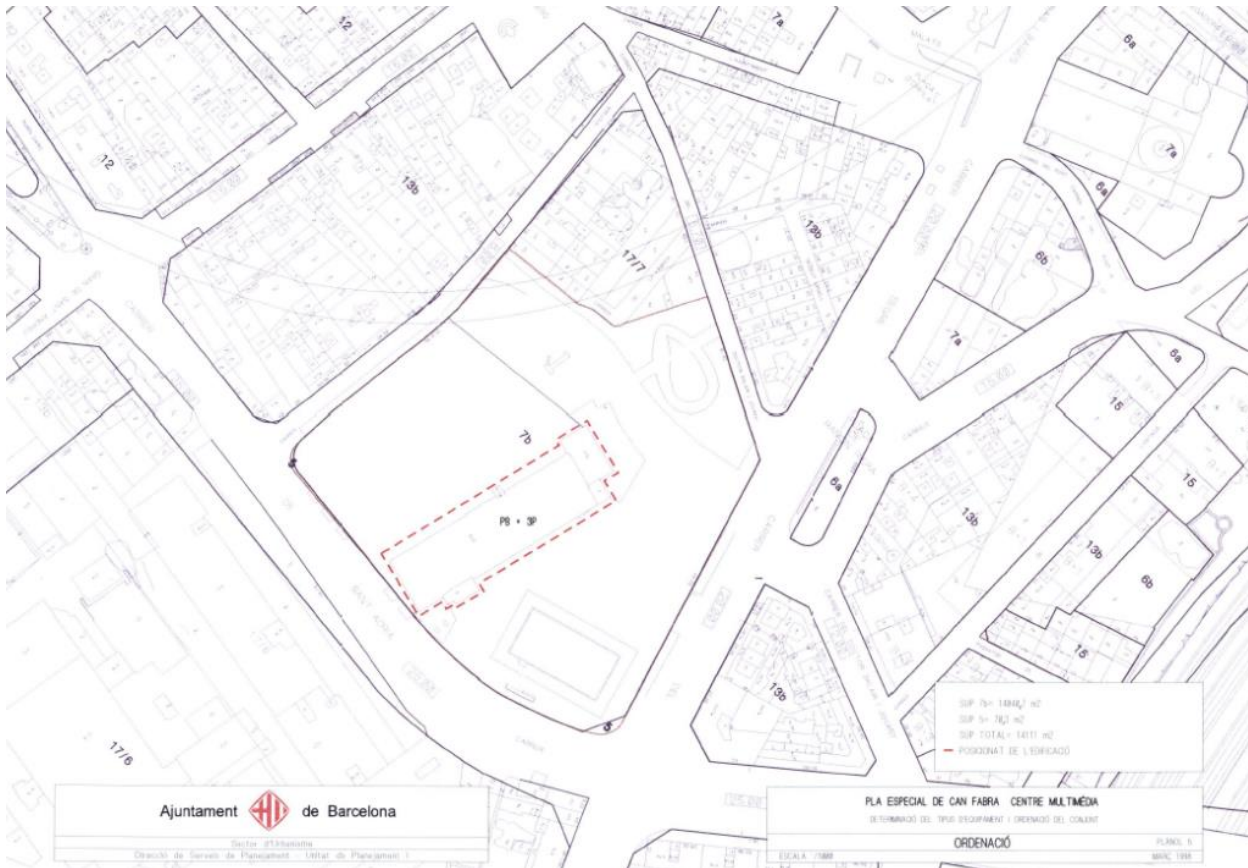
Plan Especial de Can Fabra: centro multimedia. Determinación del tipo de equipamiento y ordenación del conjunto. 1998. FUENTE: Ayuntamiento de Barcelona
